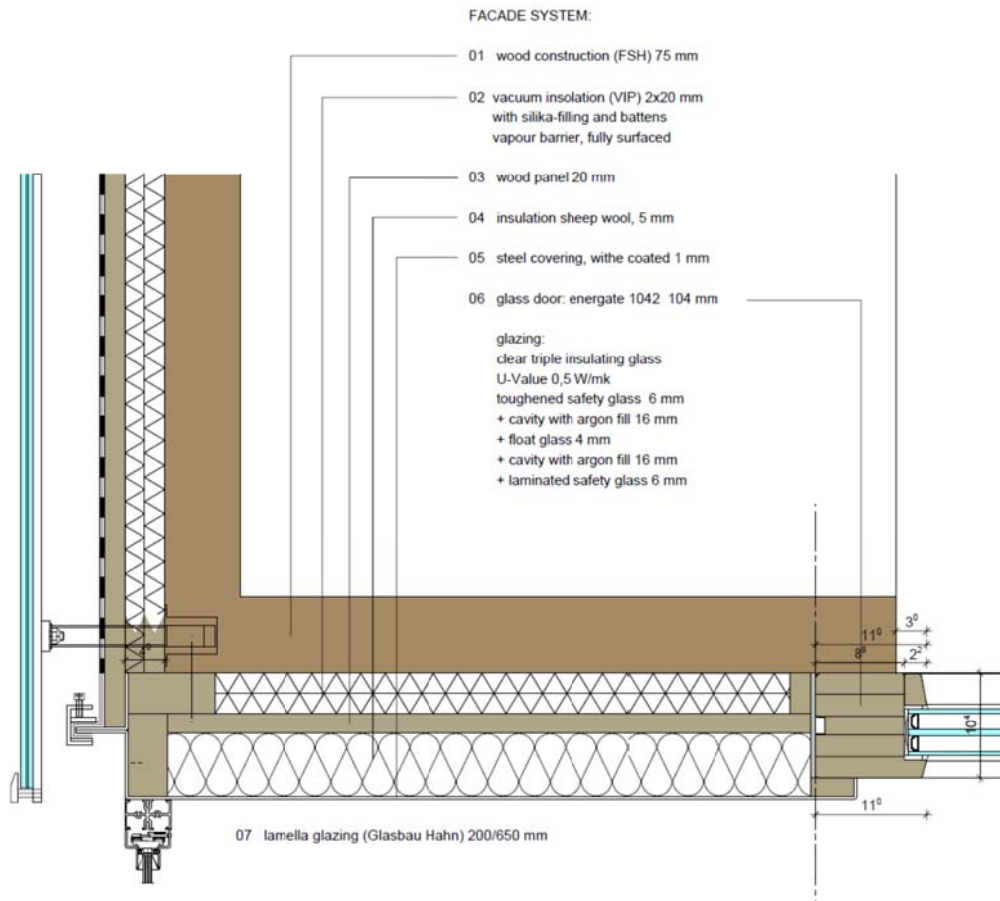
Sección encuentro fachada Este y Oeste con forjado. Fuente: HFT_CD_2010-09-22
